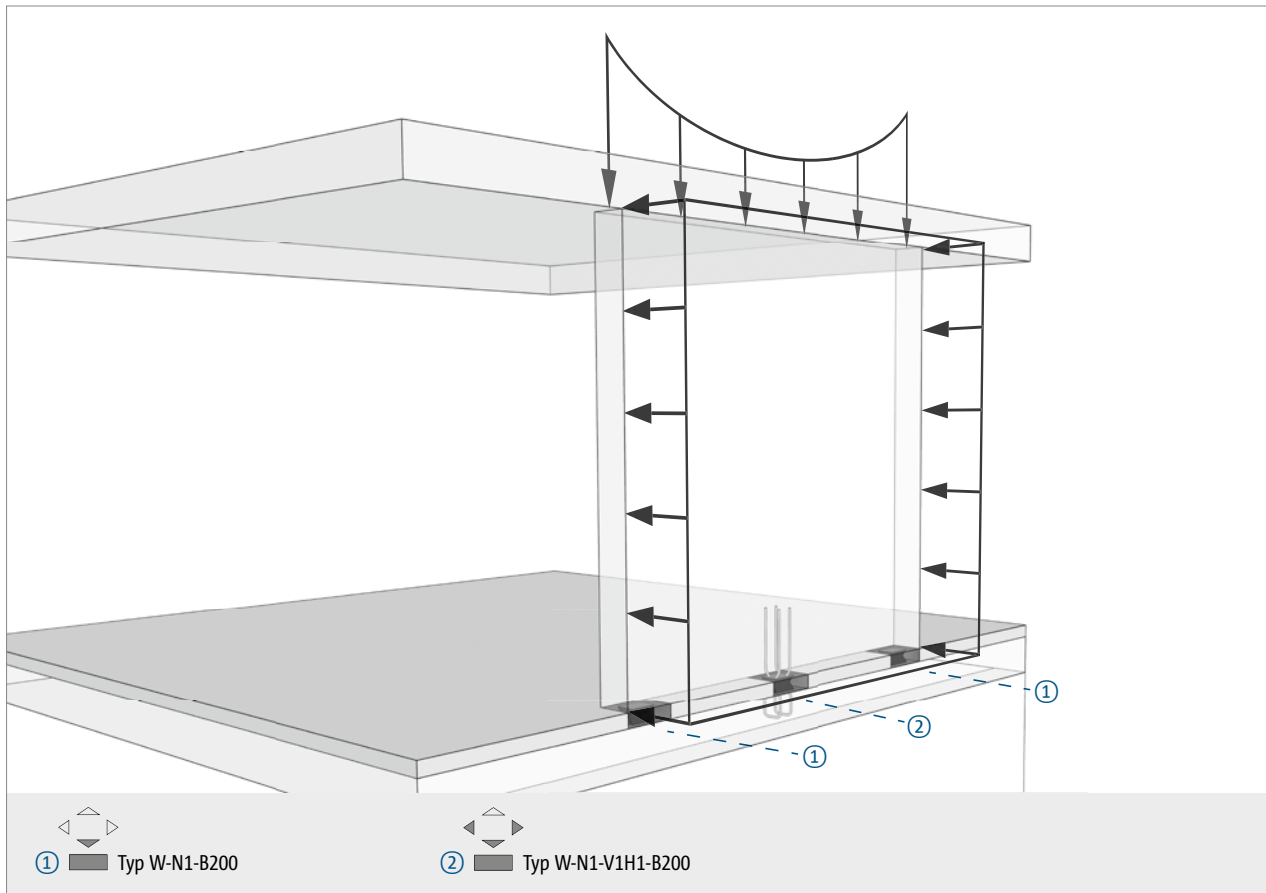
Windbelastete Fassadenwand auf der Decke getrennt
